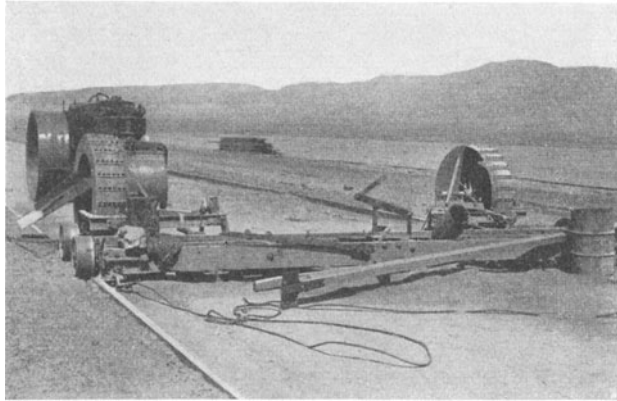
Bodenhobel mit Auswurfrädern auf einer Straßenbaustelle in Kalifornien.
